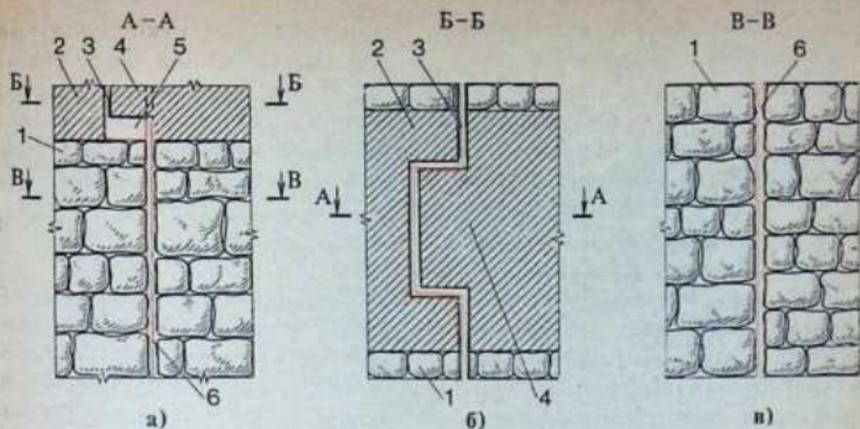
Переход от осадочного шва фундамента к осадочному шву стены:
